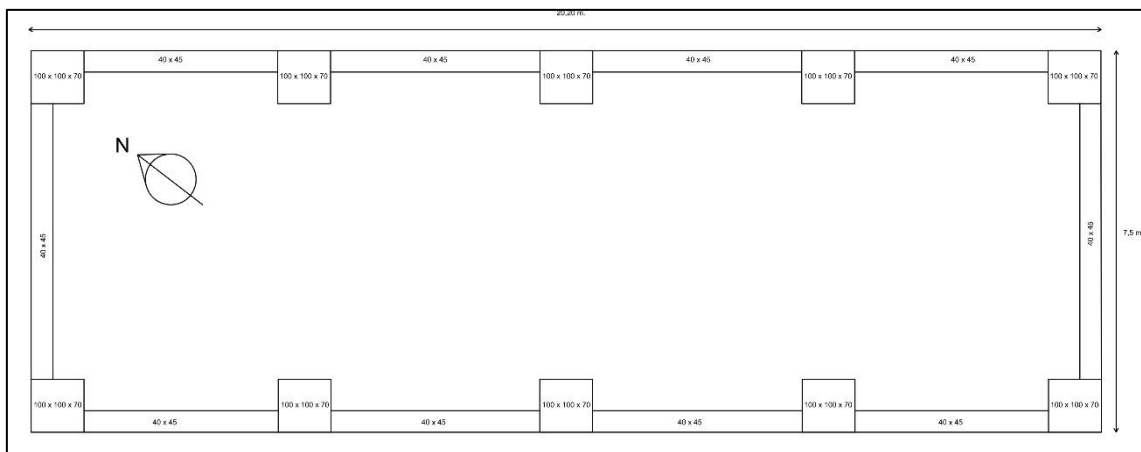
Planta de la cimentación ejecuta con las dimensiones y cotas proyectadas.
